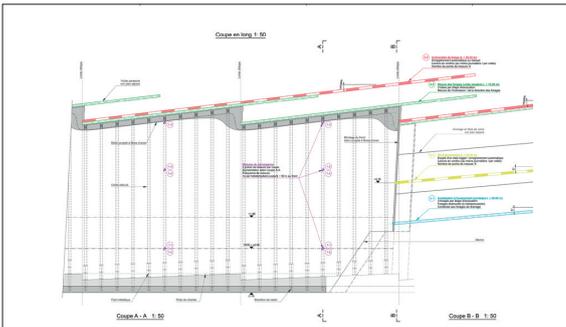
Seitenansicht eines Tunnels mit den rot markierten Testbohrungen
